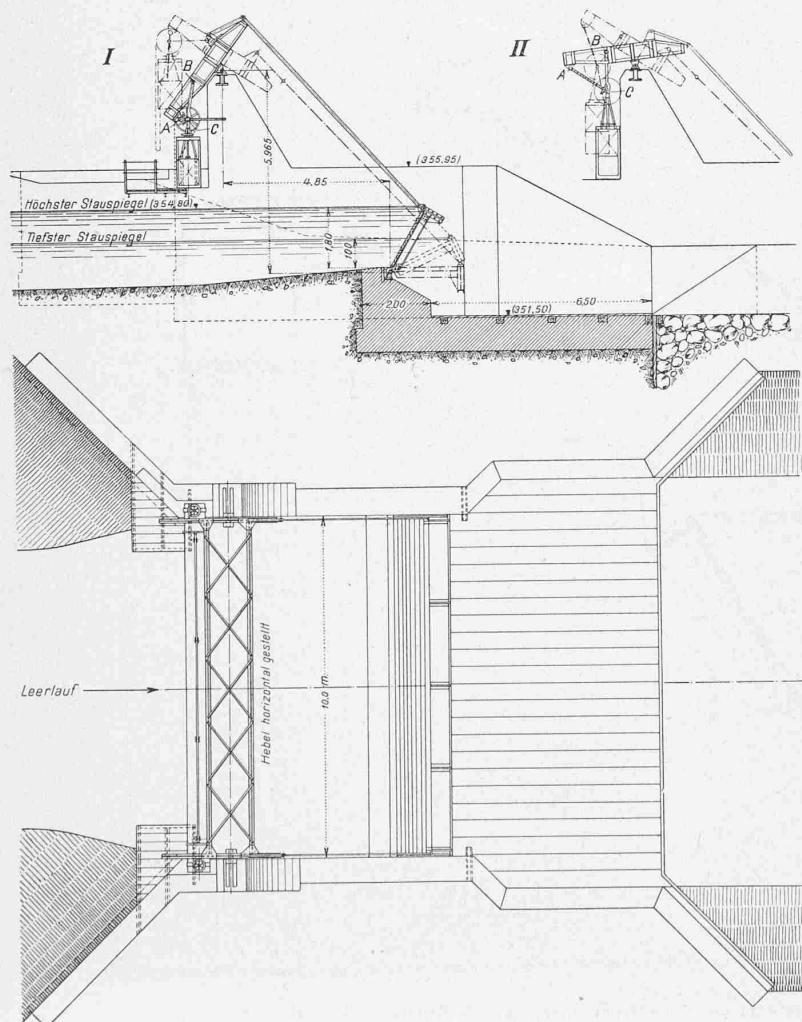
Grundriss und Schnitte. — 1:200.
